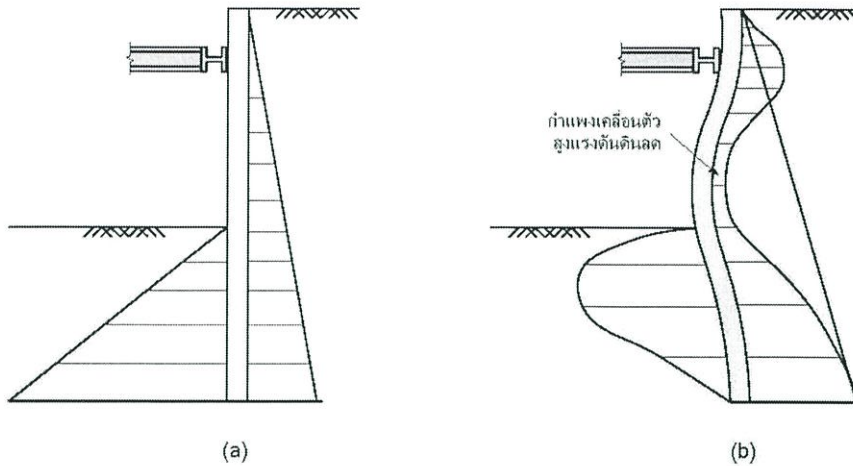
เปรียบเทียบสติฟเนสของกำแพงชนิด Rigid Wall และ Flexible Wall
